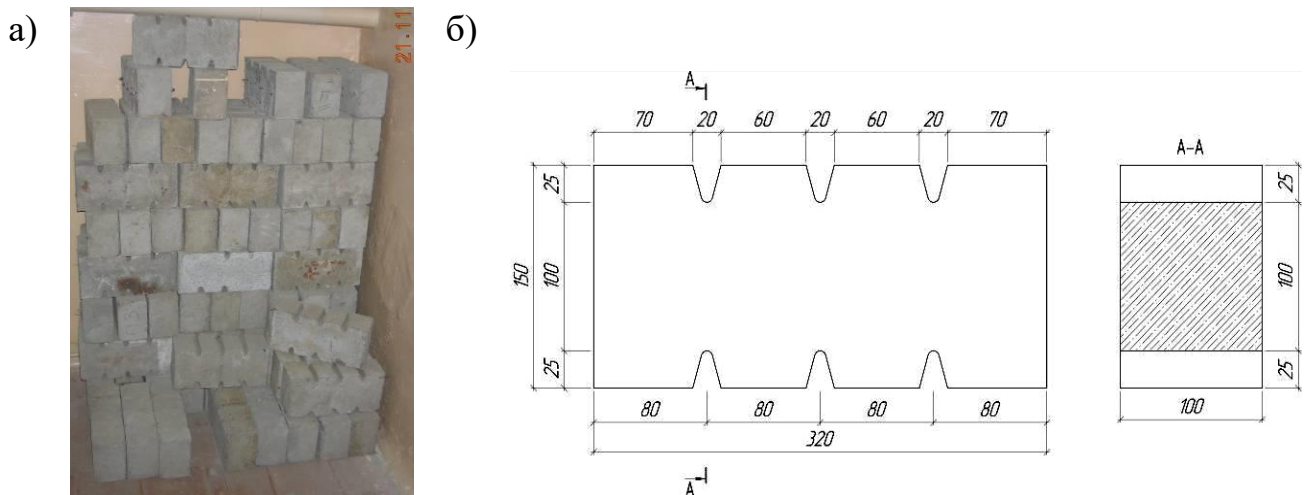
Образец для испытания: а) – партия образцов для косвенных испытаний на растяжение; б) – размеры образцов
